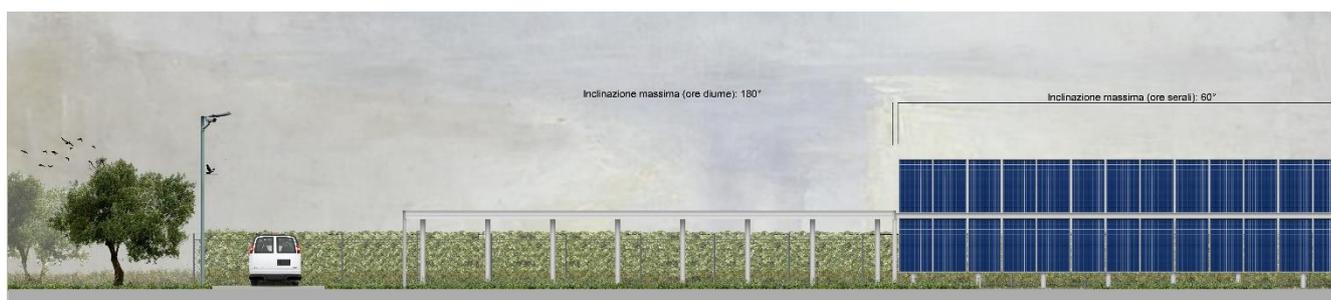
Fotoinserimento con uliveto perimetrale e rampicante esternamente alla recinzione dell'impianto "Semeraro"
